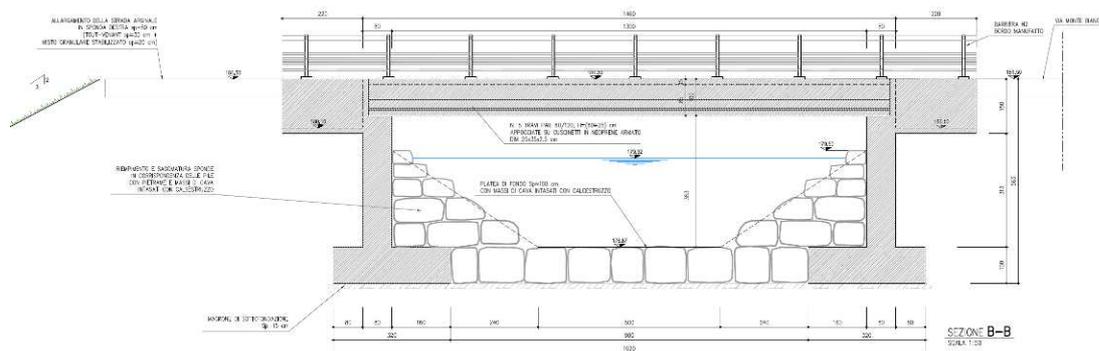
Sezione – manufatto di attraversamento Via Monte Bianco
